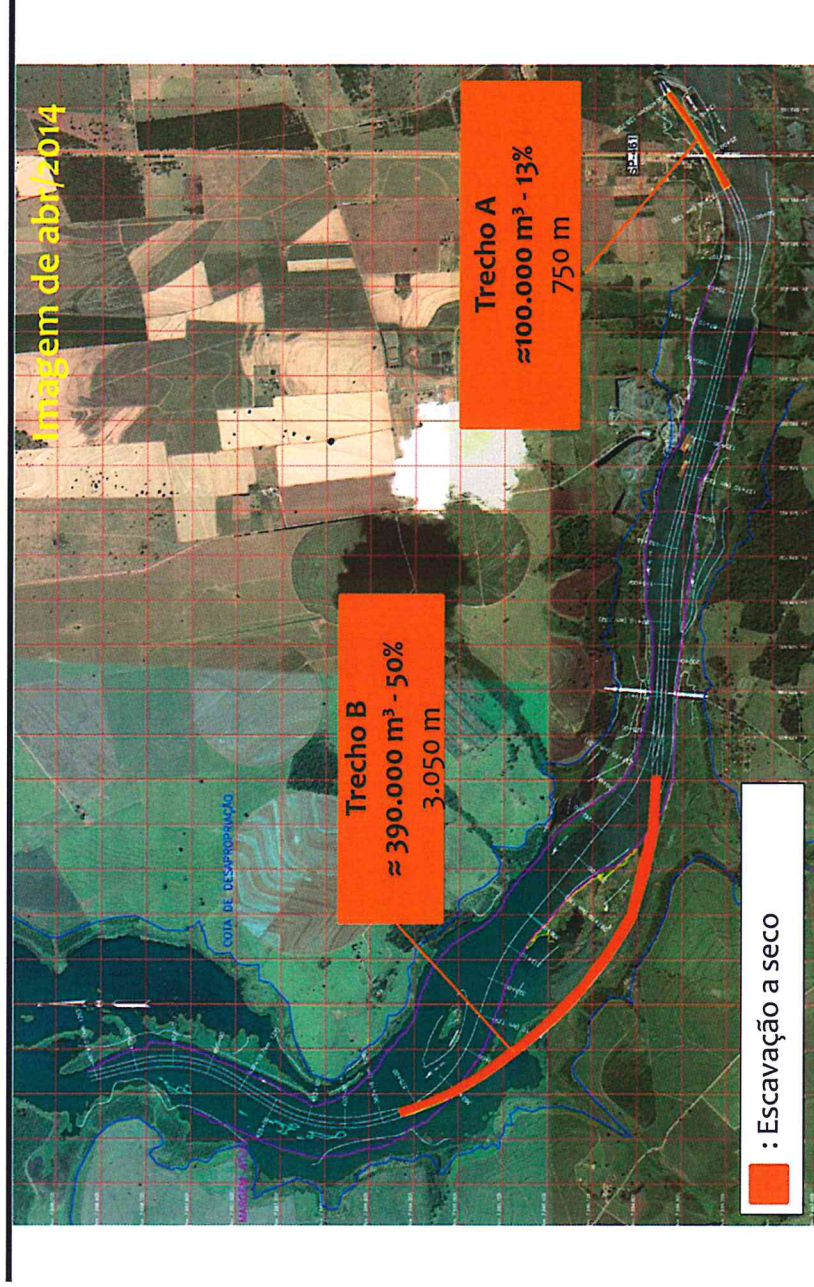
Novo traçado do Canal Jusante de Nova Avanhandava. O trecho B, indicado na cor vermelha, será executado por escavação a céu aberto, com o uso de enseadeiras
